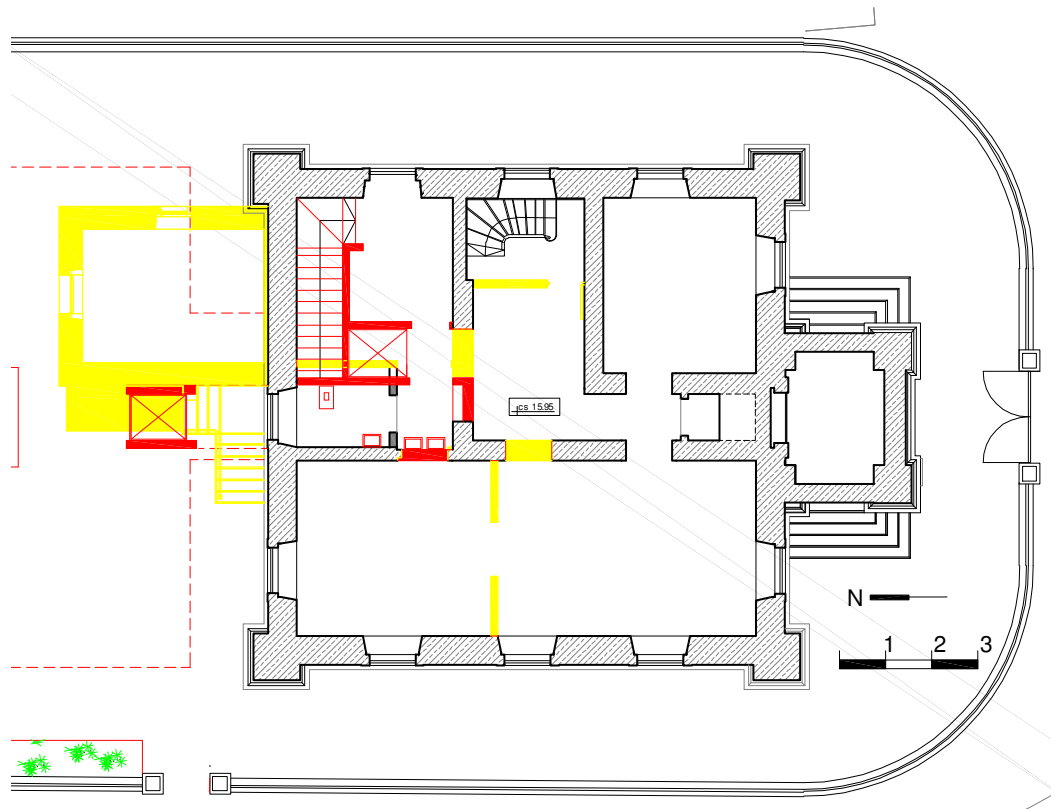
Planta do Piso Térreo com as Cores Convencionais
